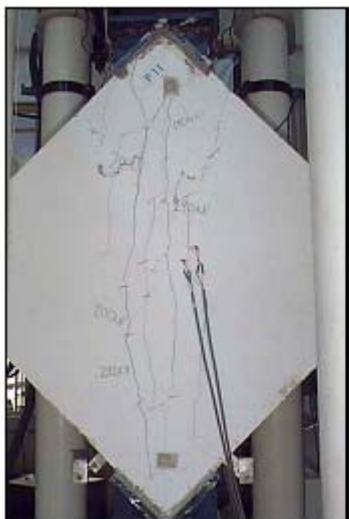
Fissuras na parede revestida com telas soldadas.
